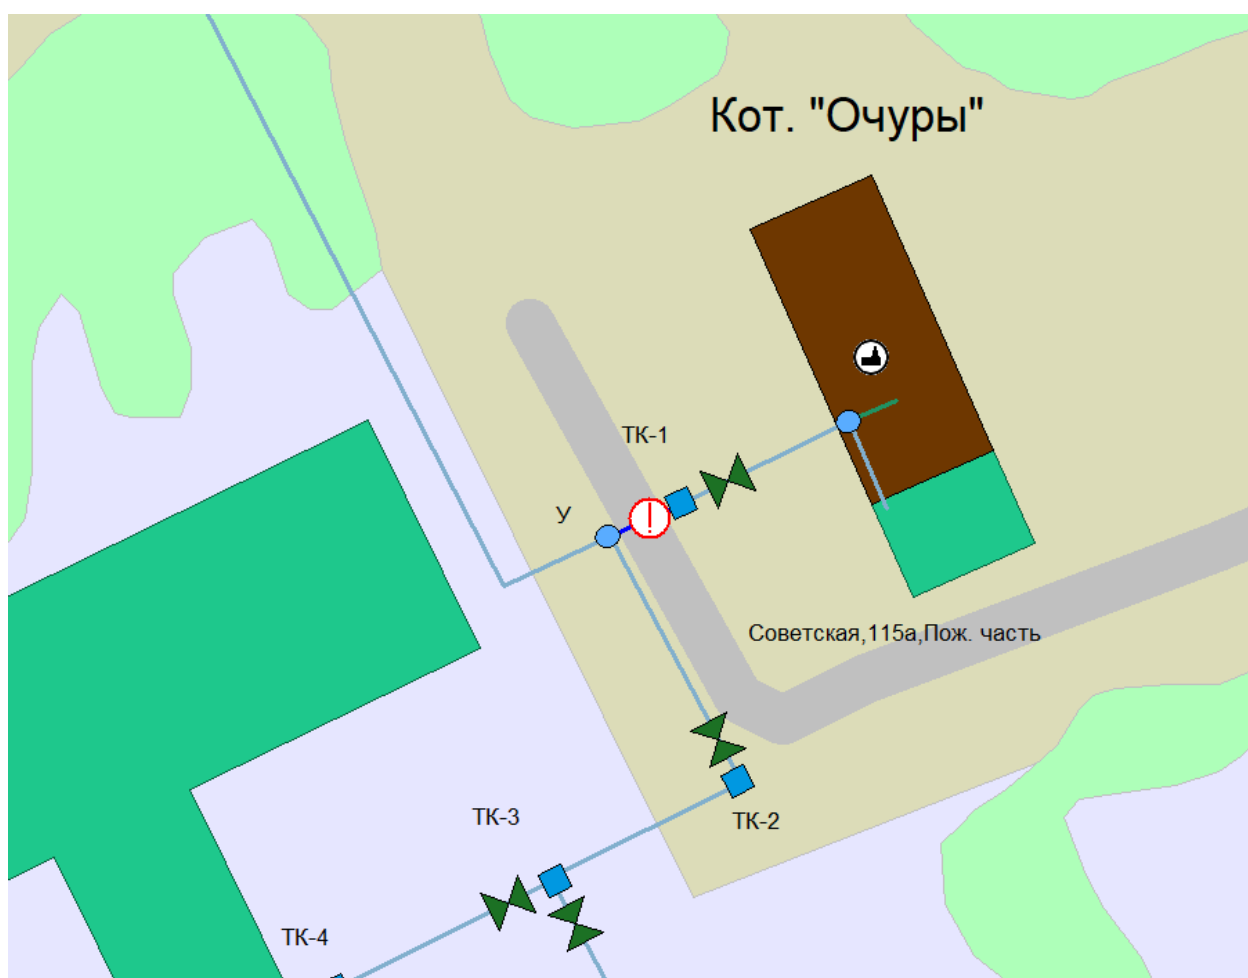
Трубопроводы, перекрытые для проведения ремонтных работ.
